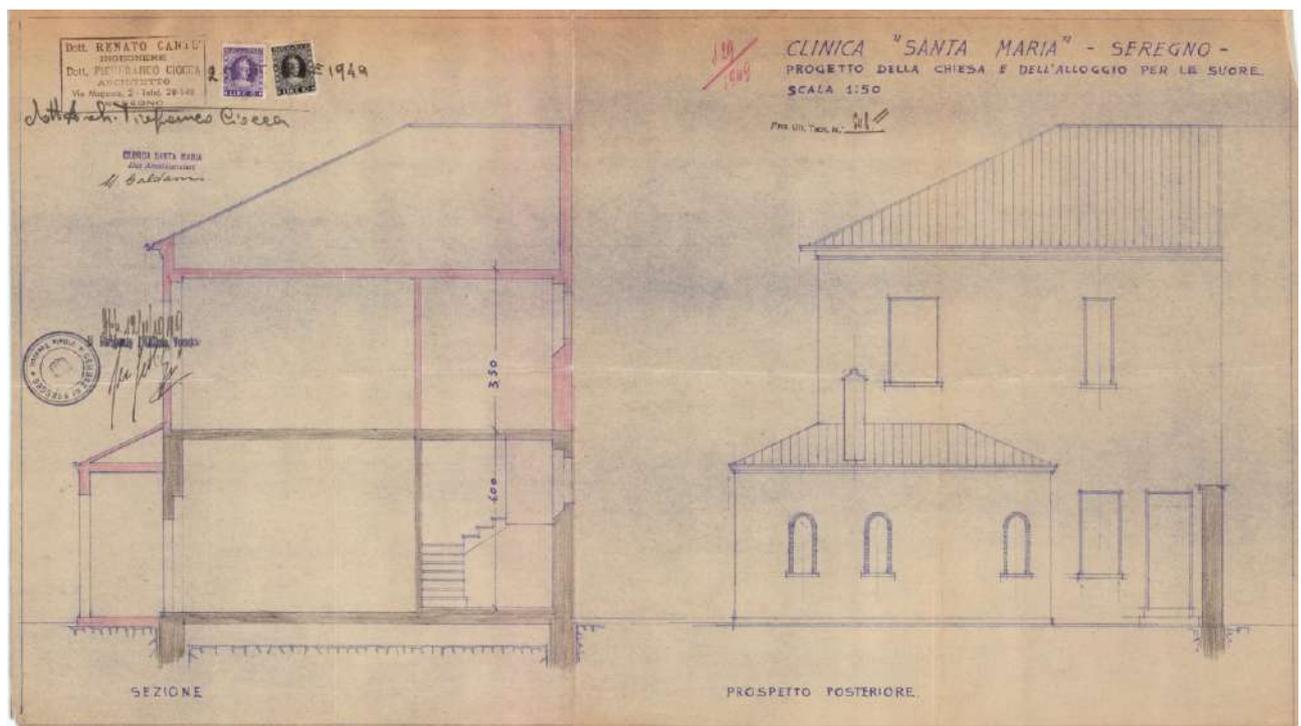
Sezione e Prospetto nord, pratica edilizia 129/1949, Archivio Comune di Seregno.
